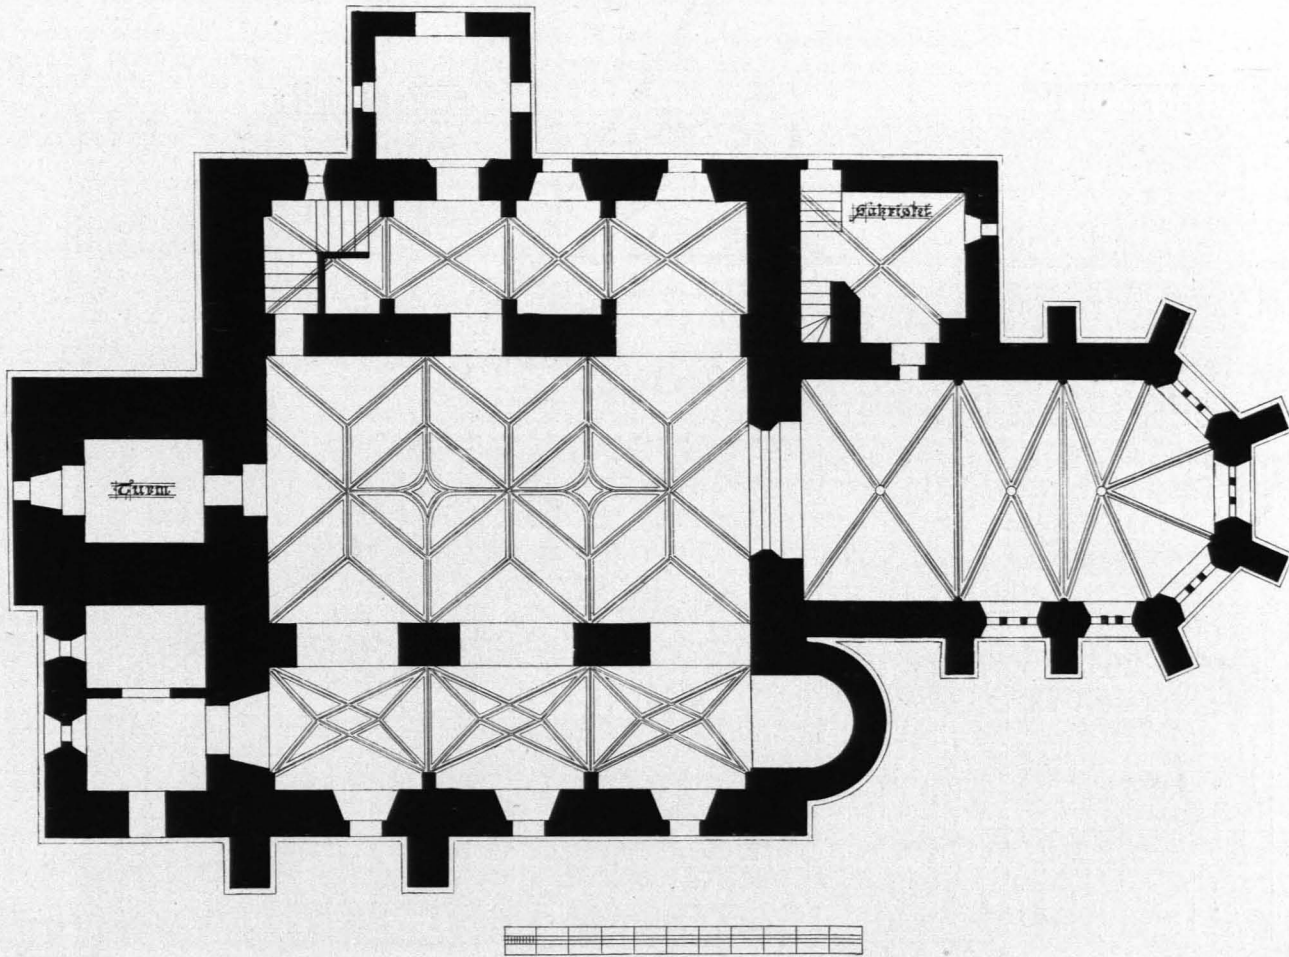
Friedersbach, Pfarrkirche, Grundriß 1 : 230 (S. 304)
